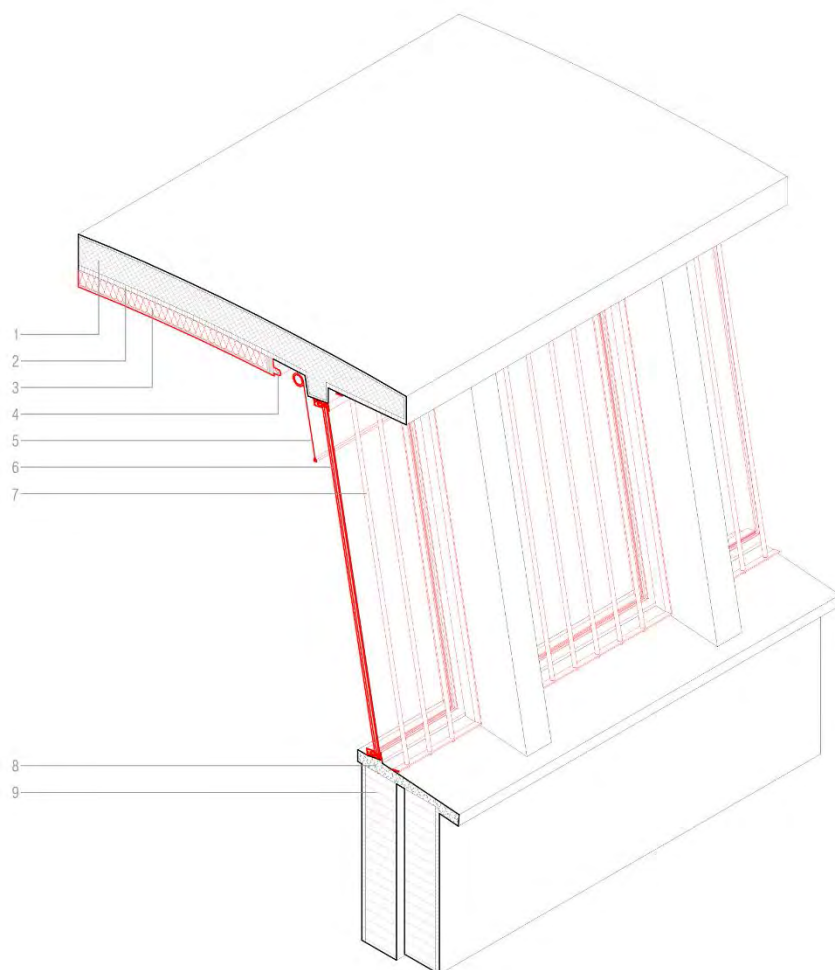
Pormenor construtivo em Axonometria com detalhes de intervenção, fachada nascente
